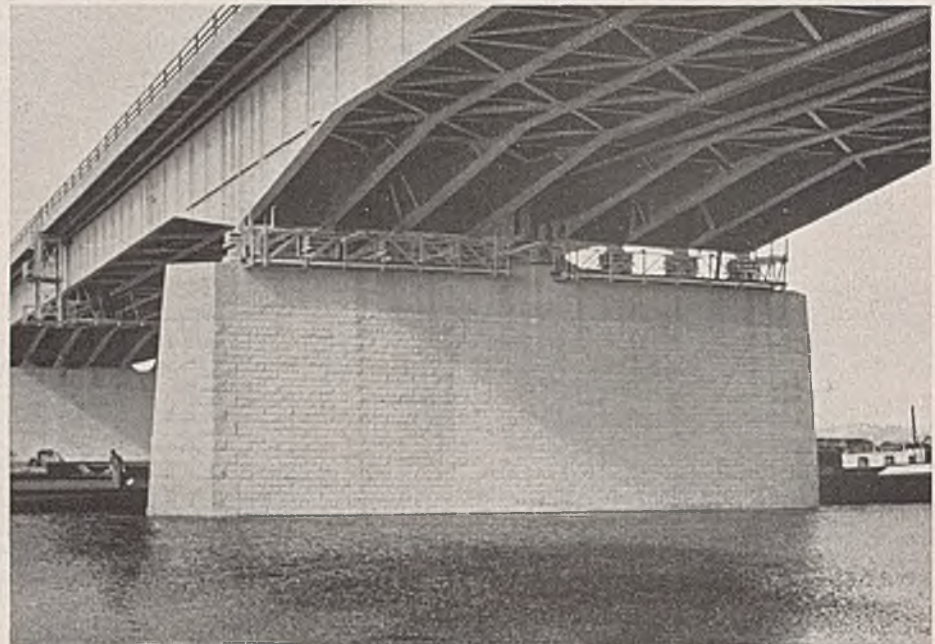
Reichsautobahnbrücke über die Oder bei Stettin. Regelmäßiges Schichtenmauerwerk.
